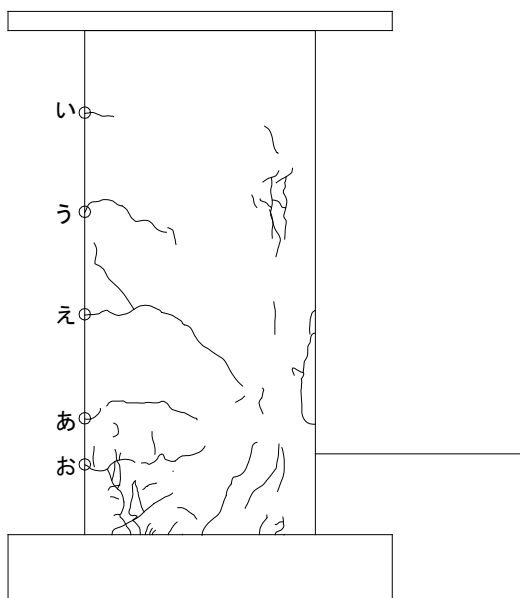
3. 252 柱ひび割れ幅測定位置(試験体 A-4 正載荷)
